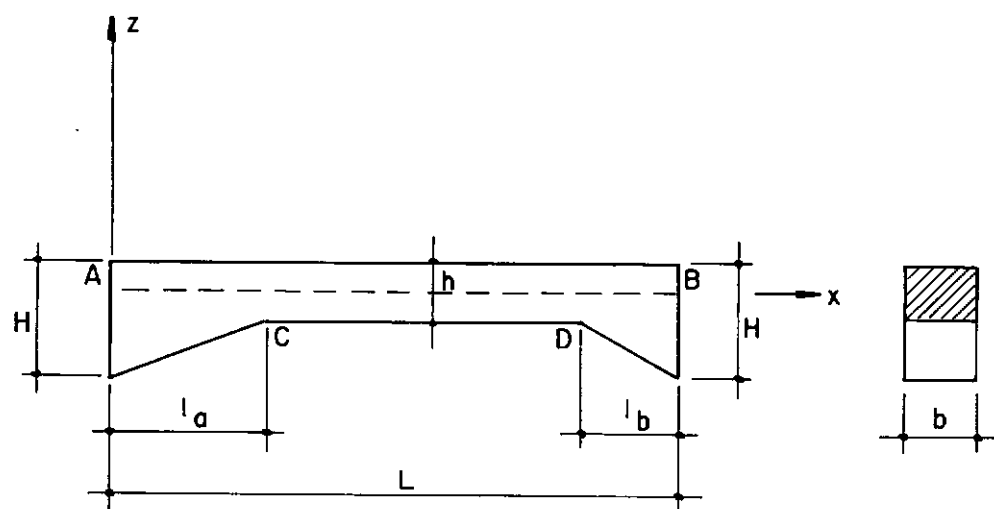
Viga de eixo reto com mísulas retas verticais.
